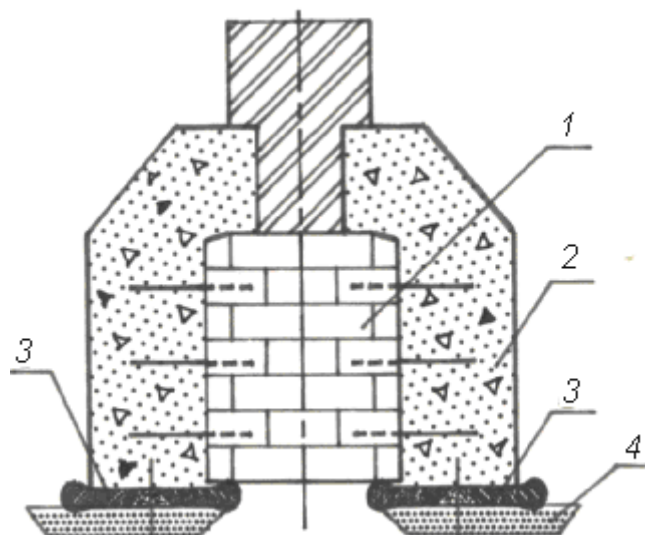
Предварительное обжатие грунтов плоскими домкратами: 1 – существующий фундамента; 2 – наращивание; 3 – плоские домкраты; 4 – щебеночно-песчаная подготовка
